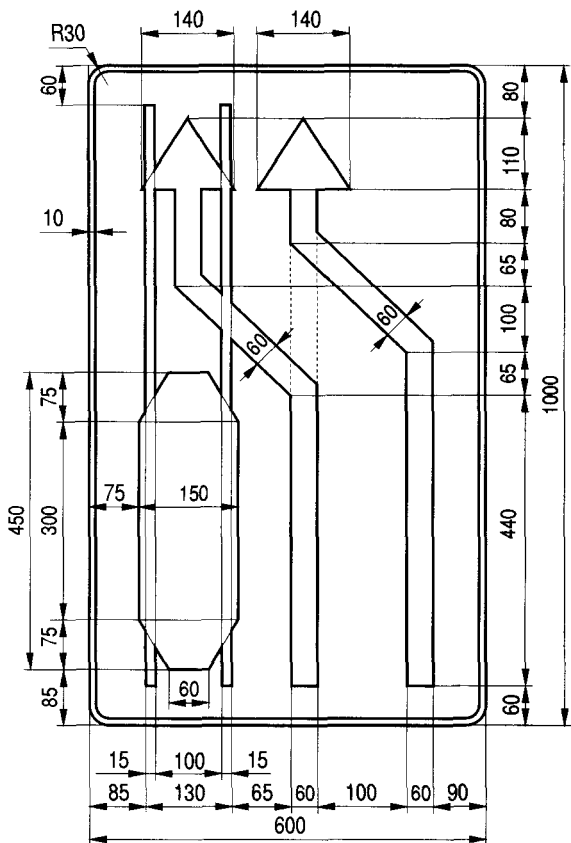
Konstrukcja tabliczki T-6c
